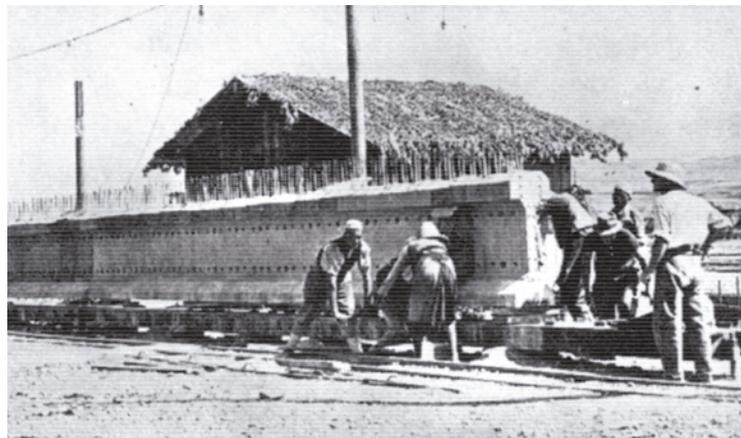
Viga de concreto protendido na Ponte de Portes de Fer
